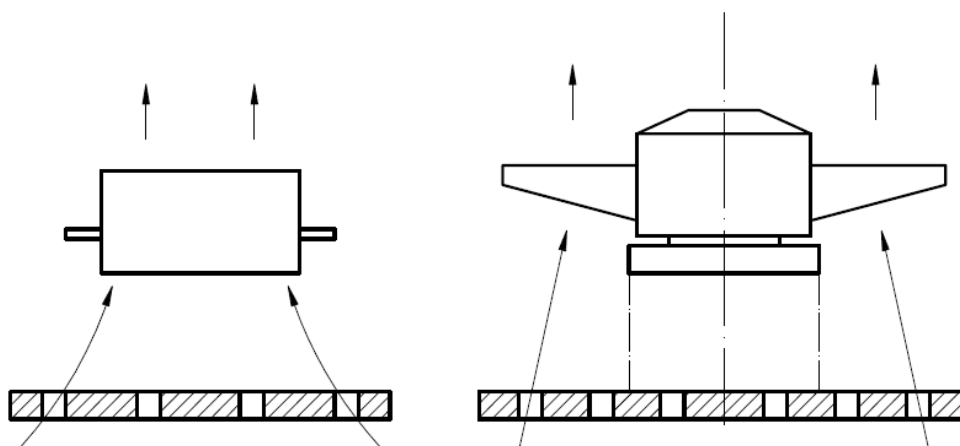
Примеры установки вентиляторов над плитой с отверстиями
